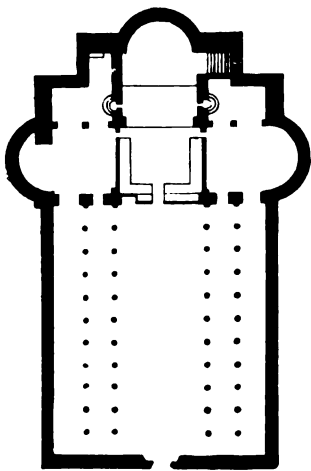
Planta de la iglesia de la Natividad en Belén.
